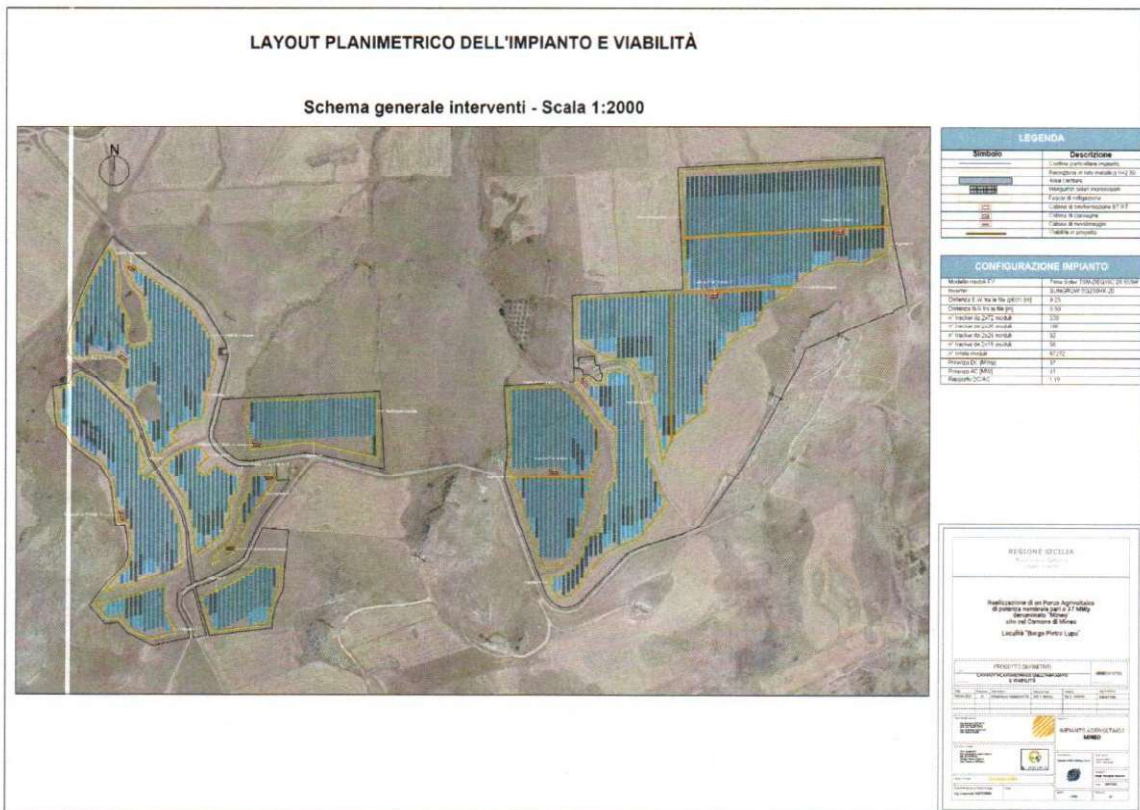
Elaborato di progetto redatto dal proponente – “Layout impianto e viabilità”
